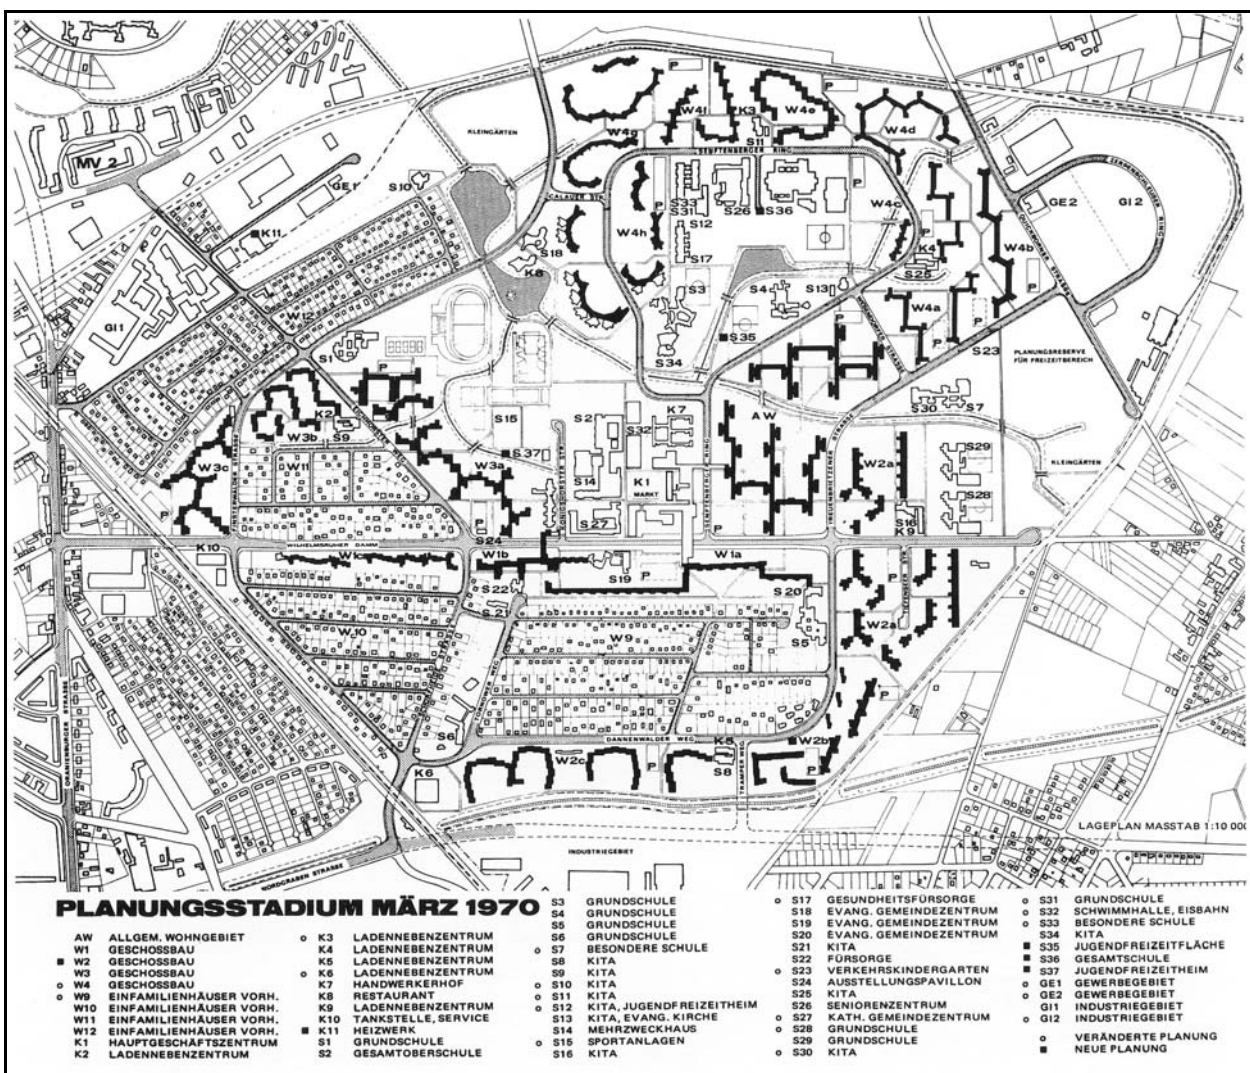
Lageplan der Großsiedlung Märkisches Viertel
